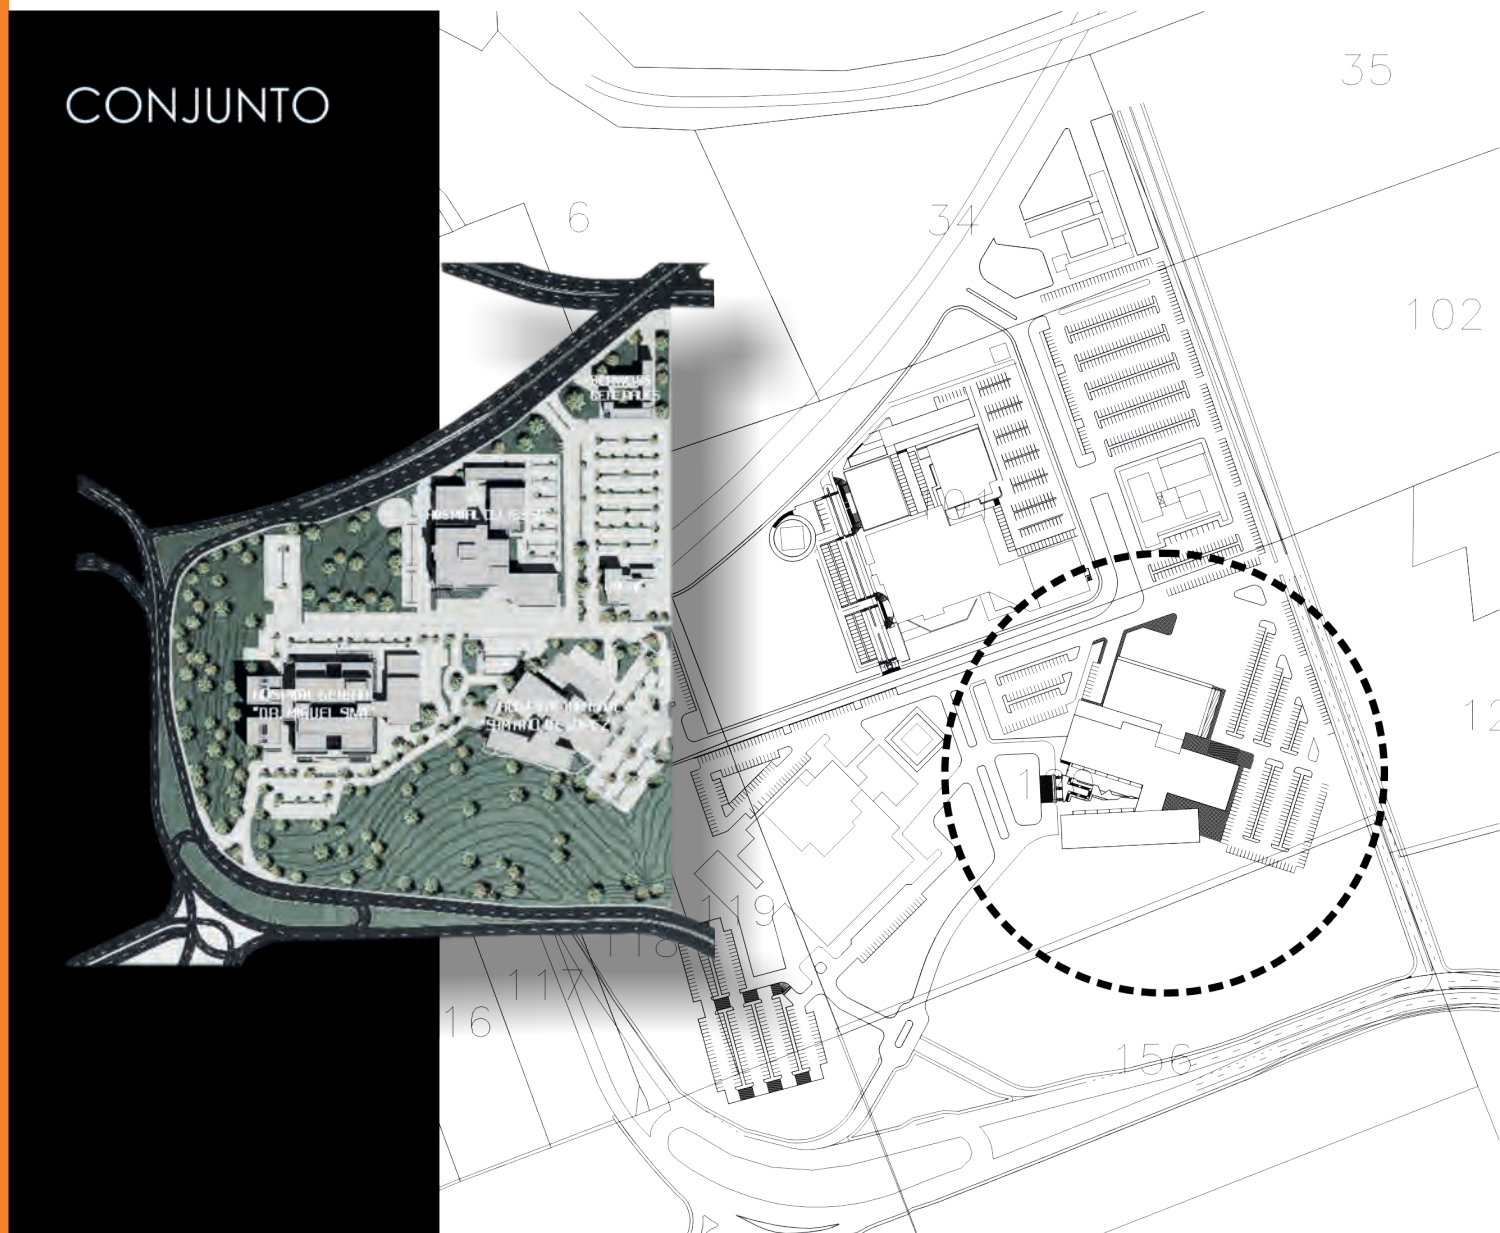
Vista de conjunto de Ciudad Salud. Planos proporcionados por Grupo Tres Marías.
